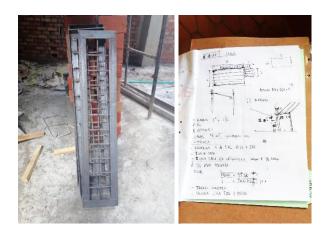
Instalación de escaleras de primer piso (28/08/19)
